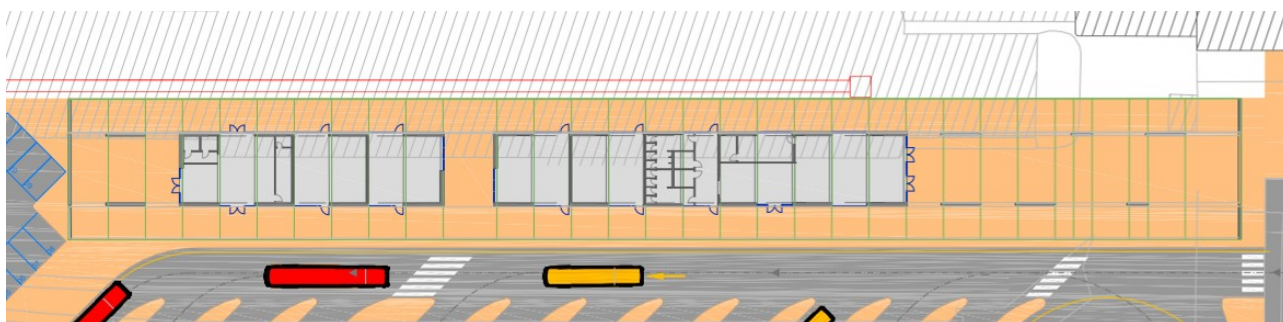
Dettaglio dell'autostazione (Sezione Piano Terra)
